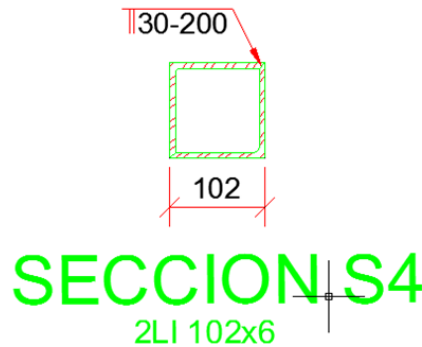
Sección 4 de la figura 5.1 para la zona central
